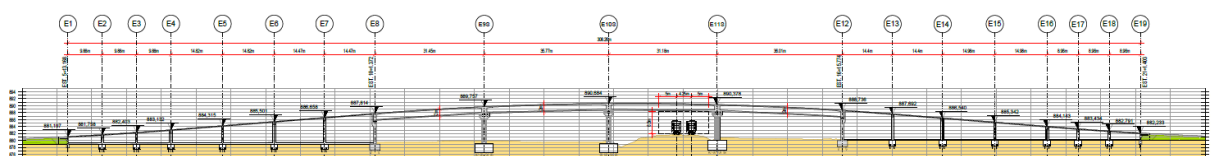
ELEVÇÃO LONGITUDINAL - RAMO 000
